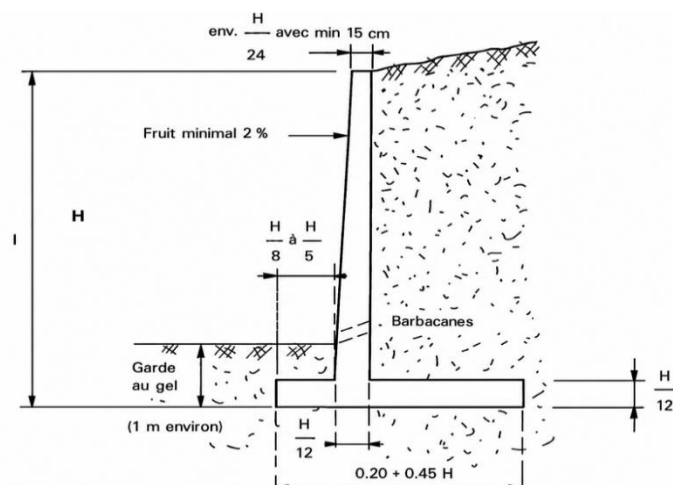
Dimensionnement courant d'un mur en béton armé
